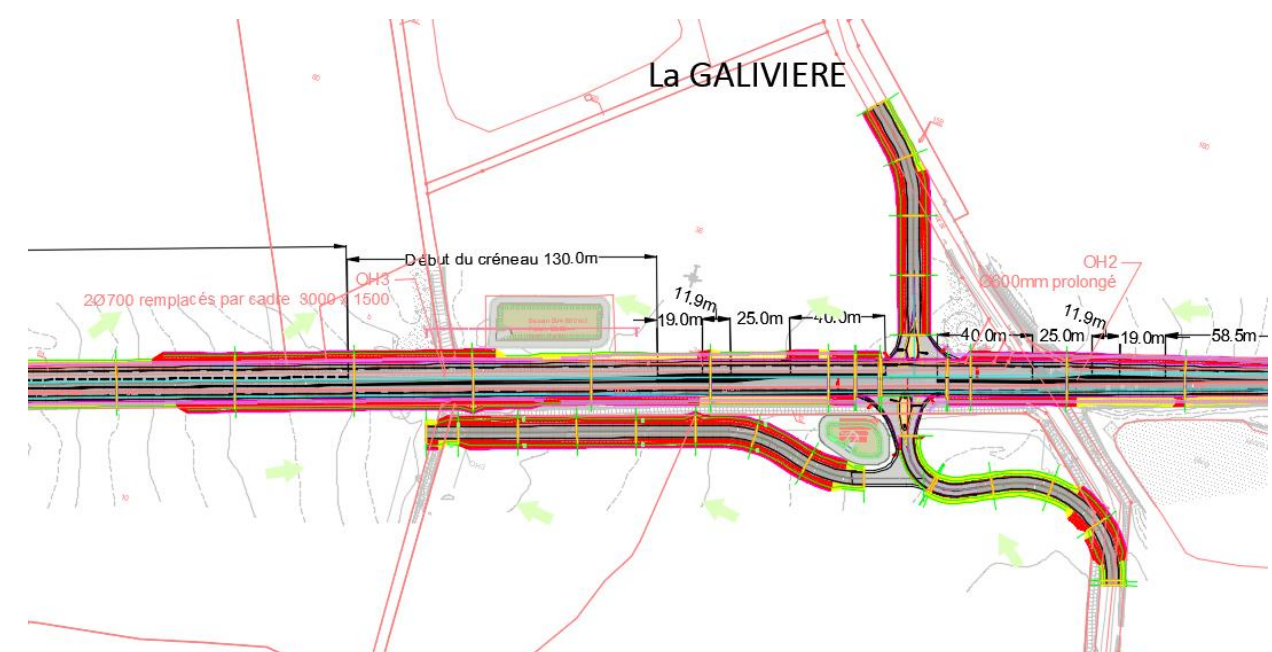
Plan du carrefour d'extrémité Est Section 1[MC1][DP2]
